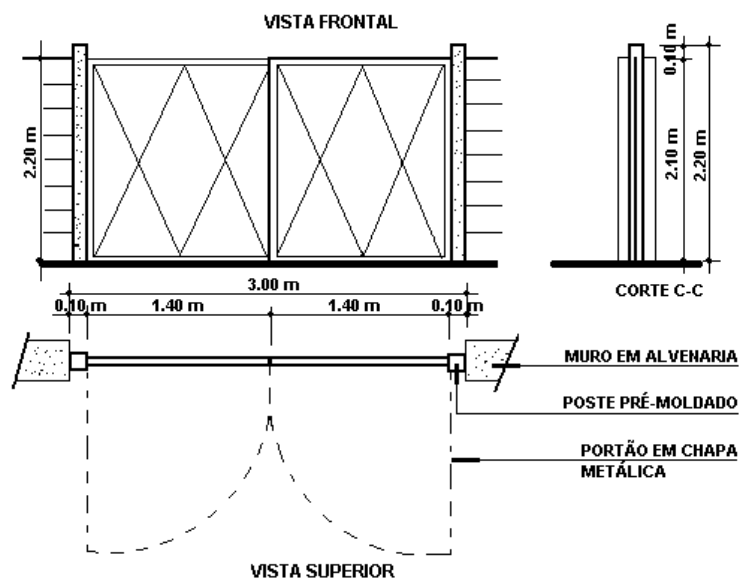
Exemplo de detalhamento técnico de implantação – portão metálico.
